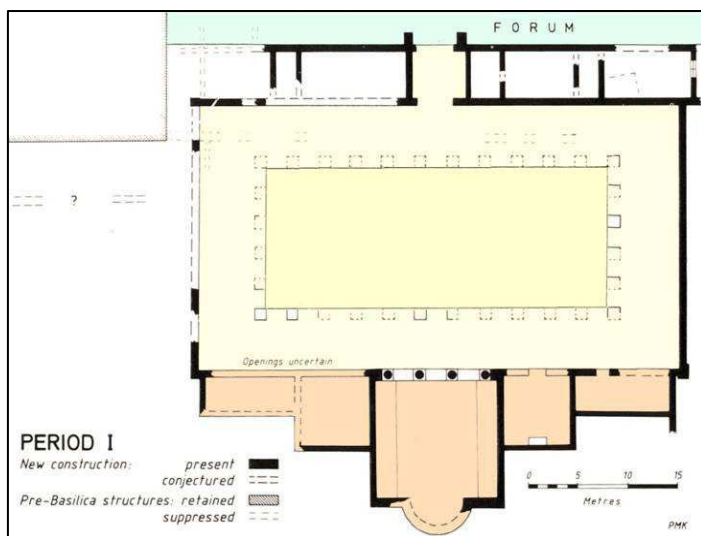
Fase I, Pianta (da KENRICK 1986).
